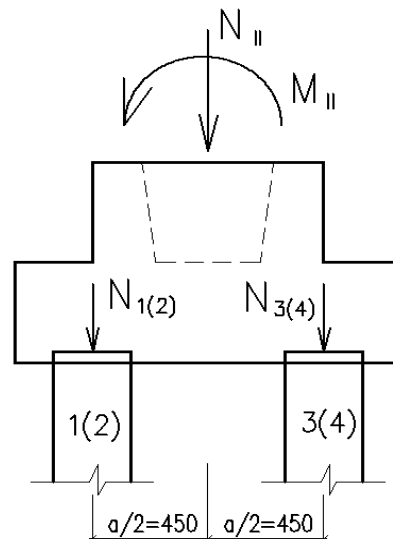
К определению нагрузок, передаваемых на сваи
